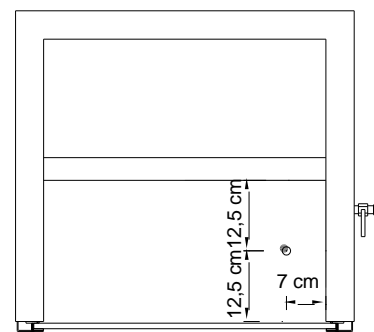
Versuchsreihe 2: Grundriss
